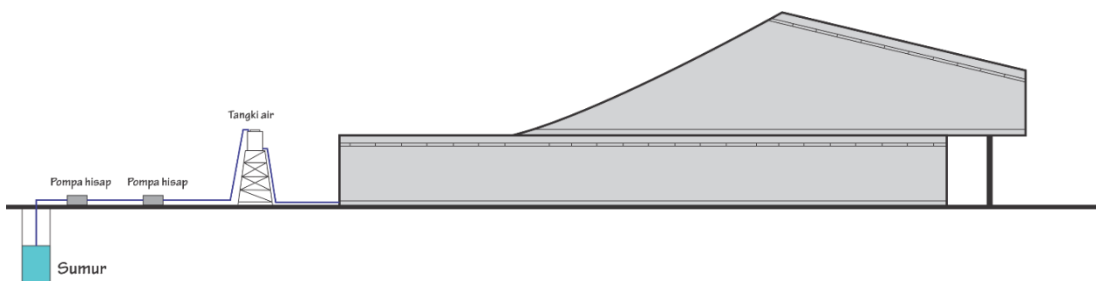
8 Konsep Bentuk dan struktur Bangunan
